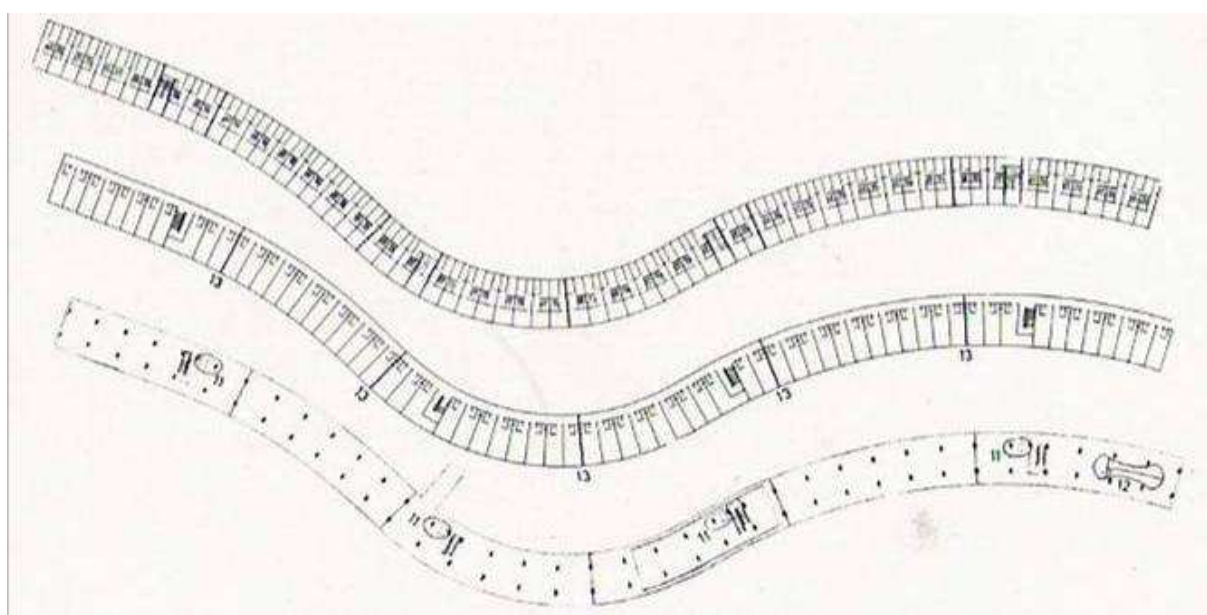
PLANTA DO 5º E 7º PAVIMENTOS (ACIMA), PLANTA DO 1º E 2º PAVIMENTOS
